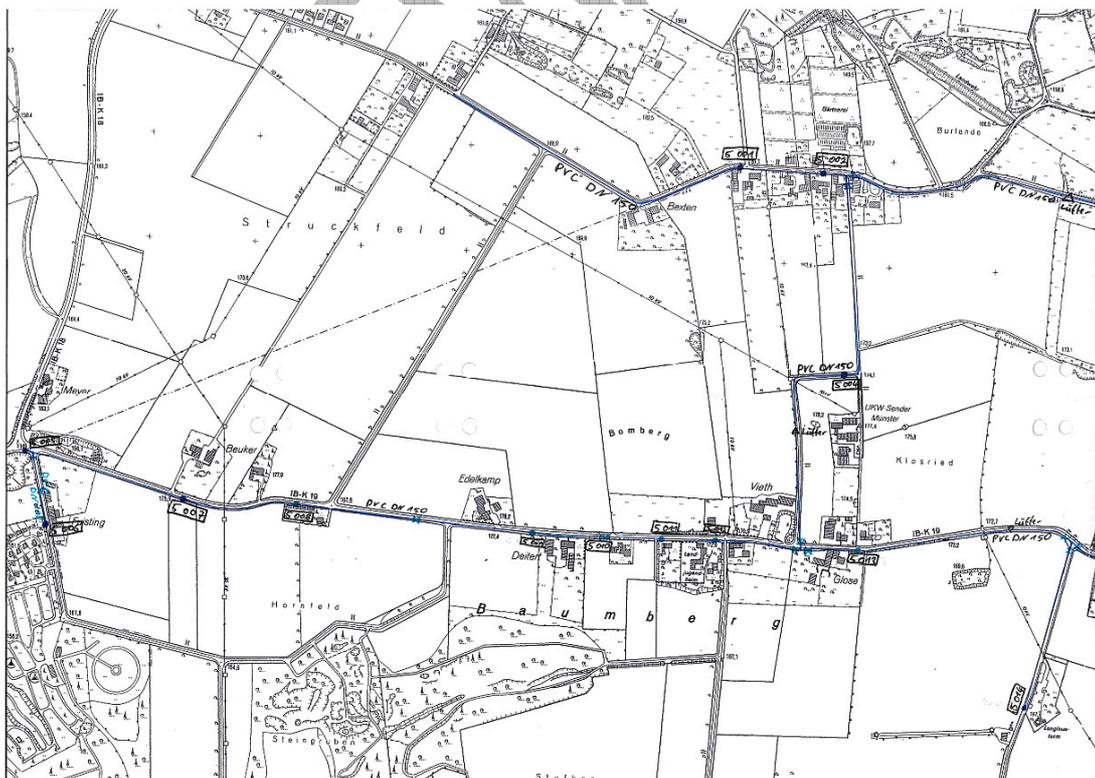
Trinkwasserversorgungsnetz mit Hydranten, Detailplan Baumberg
